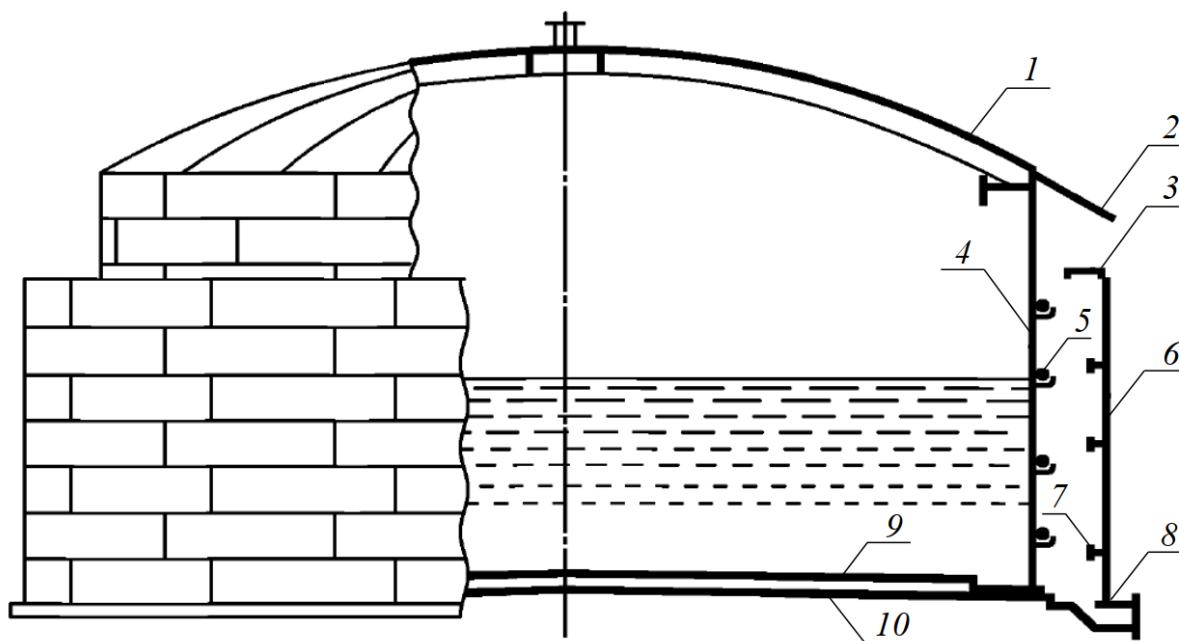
Конструктивное решение резервуара с защитной стенкой:
